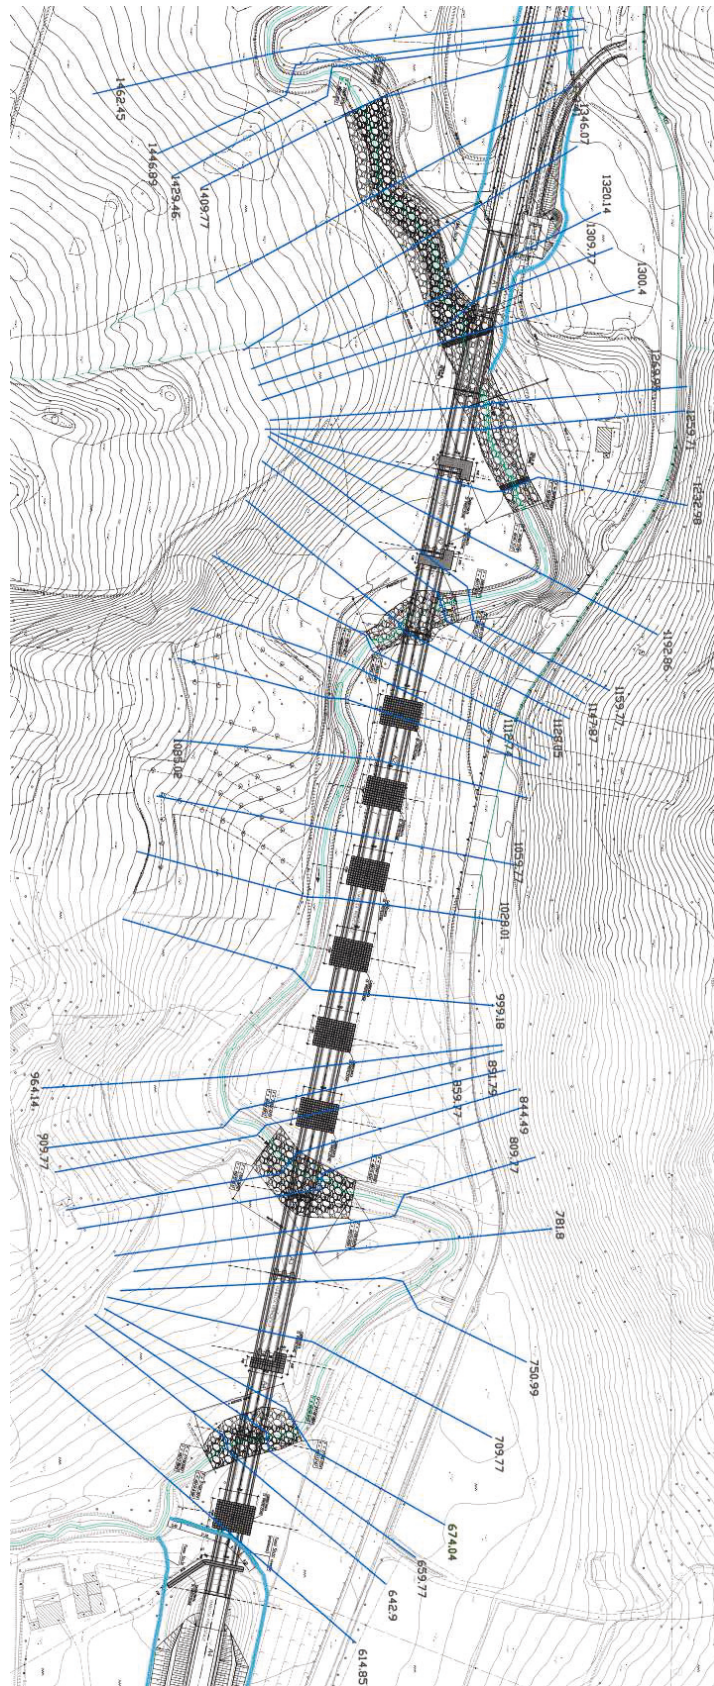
Ubicazione planimetrica sezioni di calcolo in corrispondenza della sistemazione SF11
